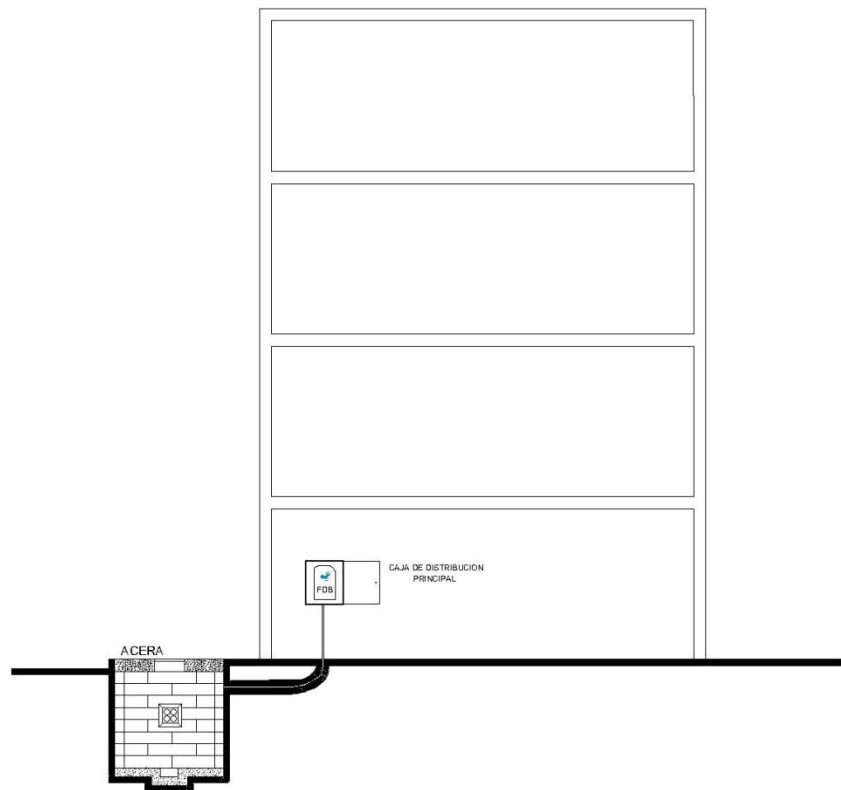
Pozo de ingreso al edificio, pozo de 48 bloques y tubería de 51 mm
